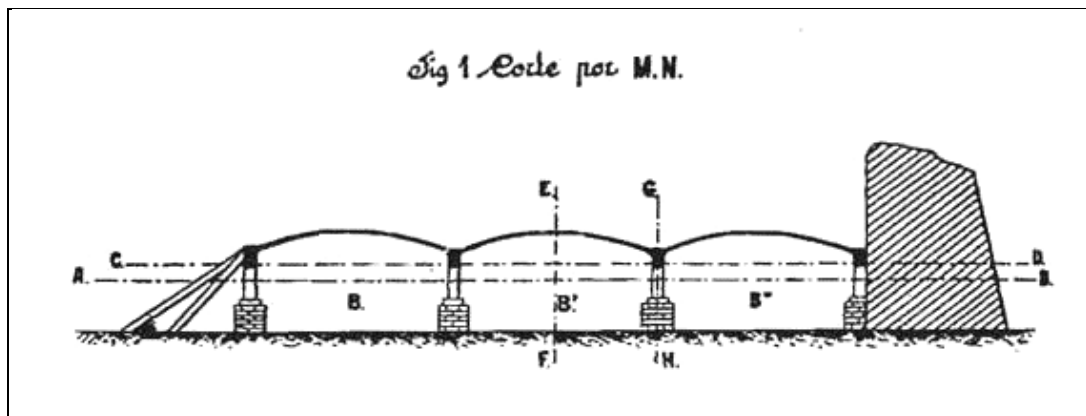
Imagen de las bóvedas del ensayo de Gijón. Revista El Cemento Armado No.2 año 1903
